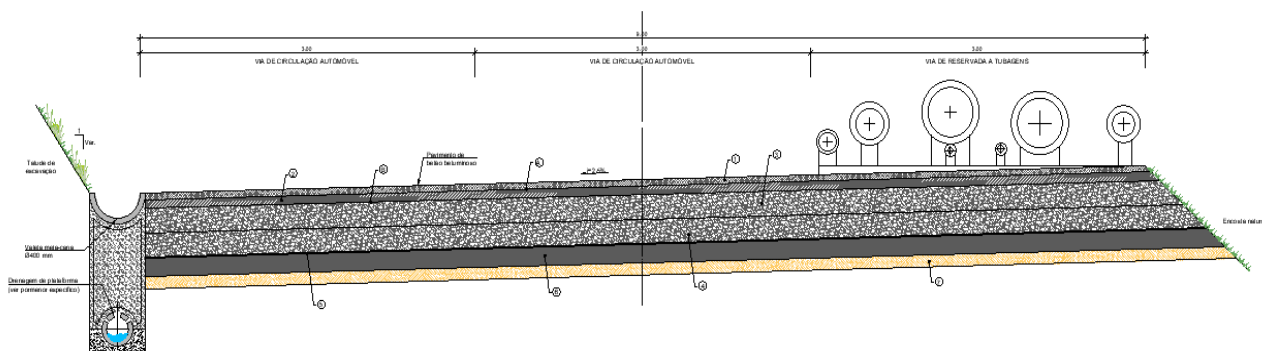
Perfil transversal tipo – Plataforma 9,0 m
